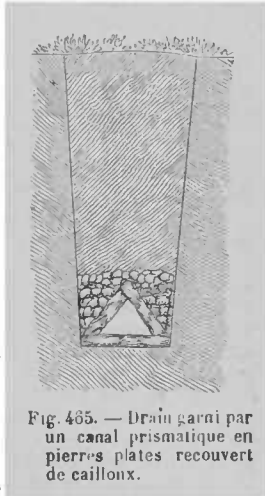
Drain garni par un canal prismatique en pierres plates recouvert de cailloux.
